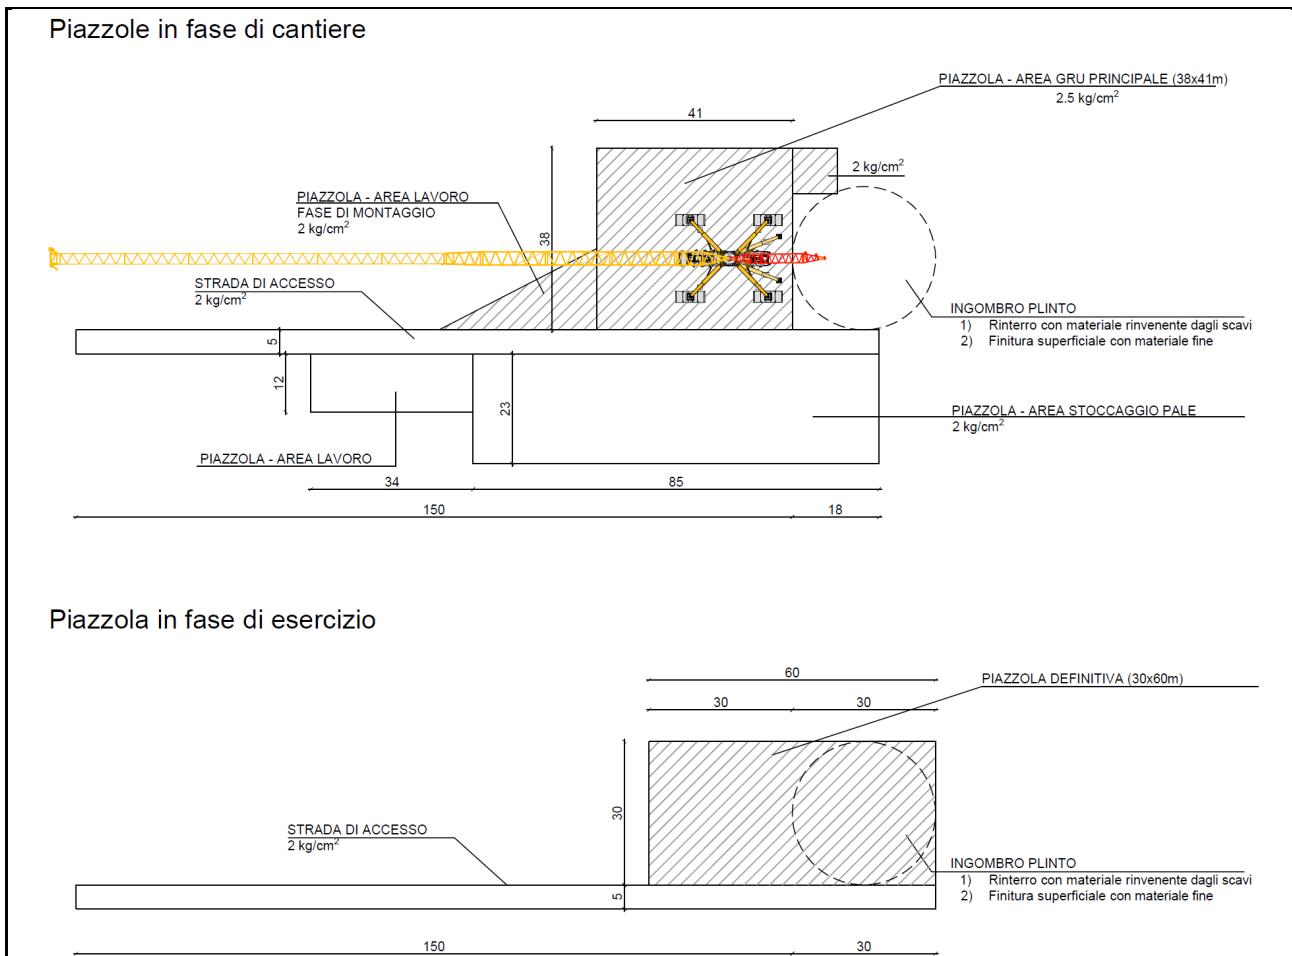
Planimetria piazzola tipo per la fase di installazione e fase di esercizio e manutenzione
